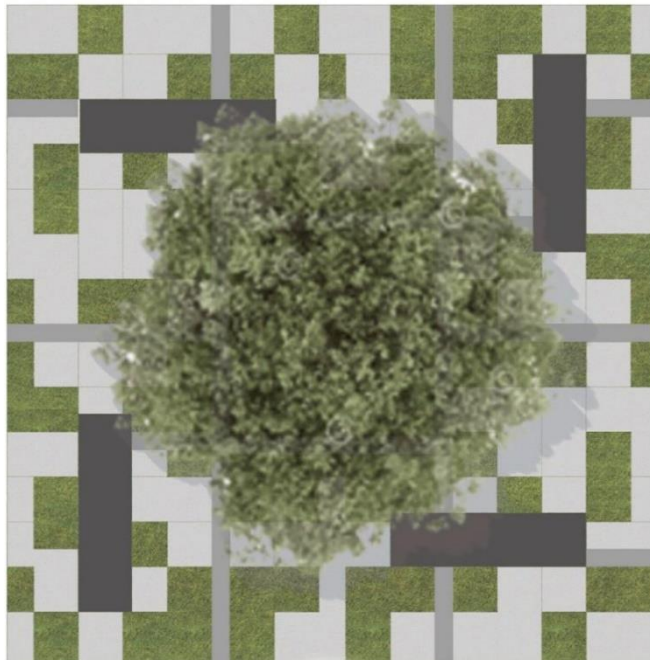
Vista 3d en Planta de Estancia Modular Propuesta
